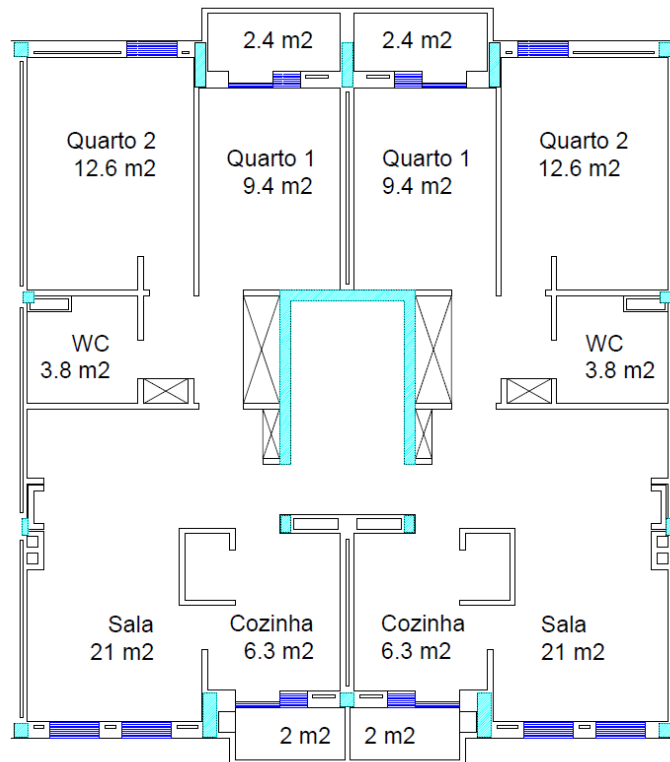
Planta tipo T2-T2 (1º; 2º; 3º)
